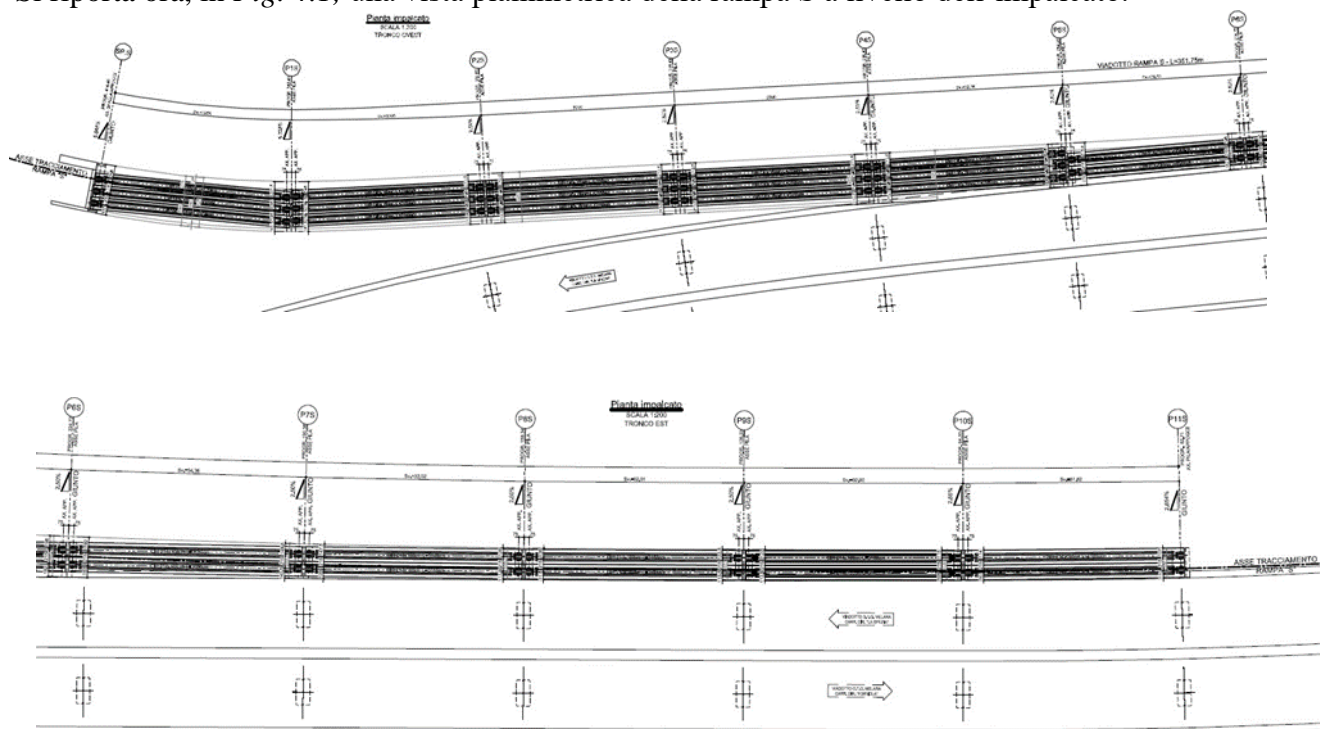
Planimetria Rampa S svincolo Melara
